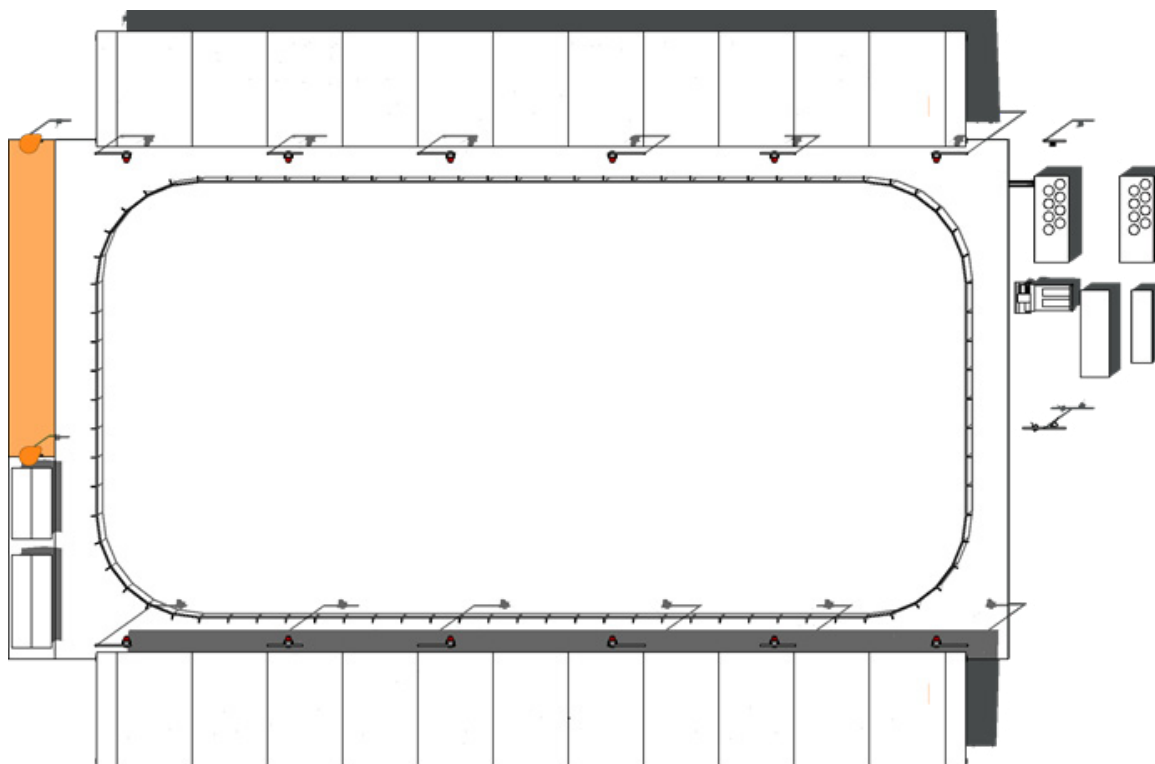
disposizione degli apparecchi per l'illuminazione dell'area di ingresso
